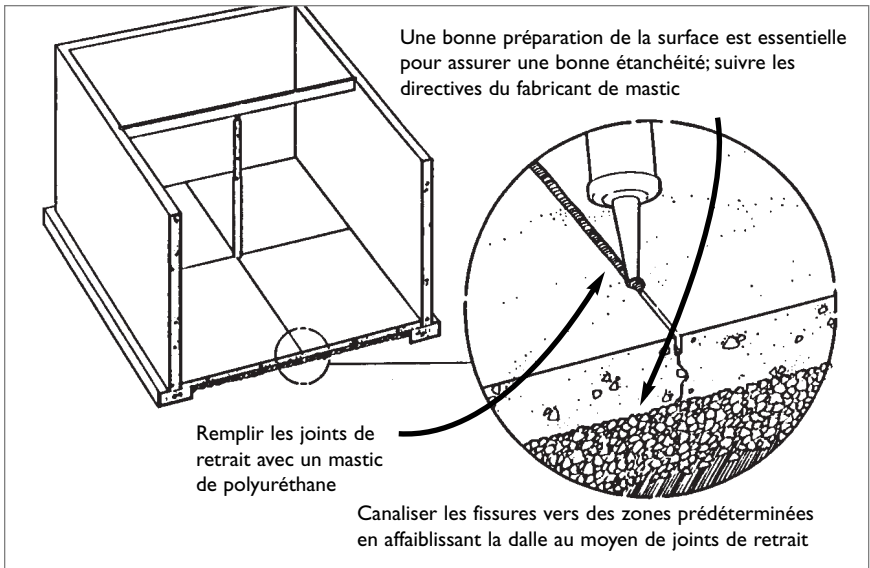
Joints de retrait pour les nouvelles dalles de plancher en béton
